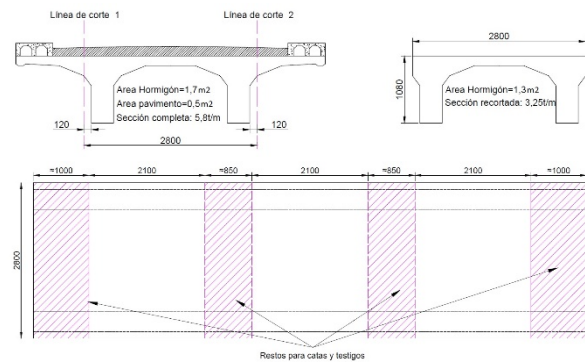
Cortes en la viga para obtener las piezas a ensayar a punzonamiento.
